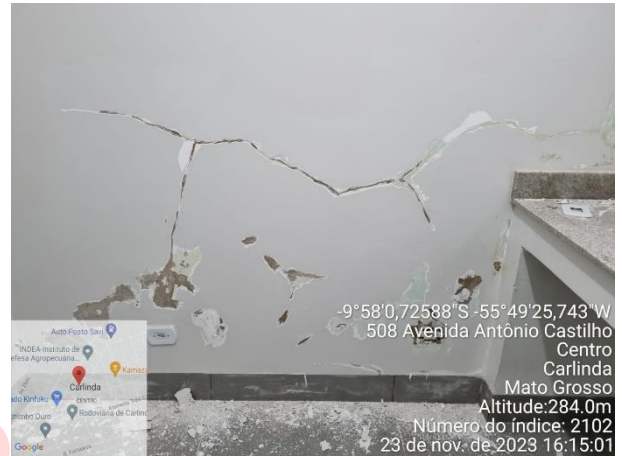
Parede com sinais de infiltrações e revestimento danificado.
